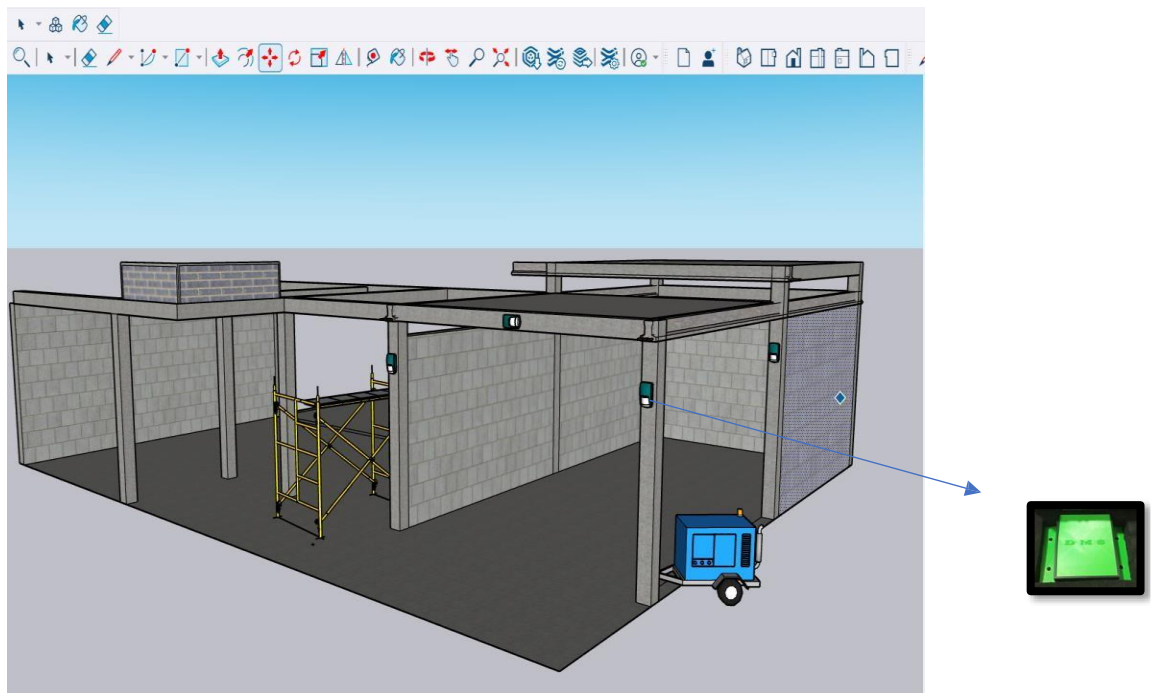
Colocación de prototipo en vigas y columnas. Fuente: El autor.
